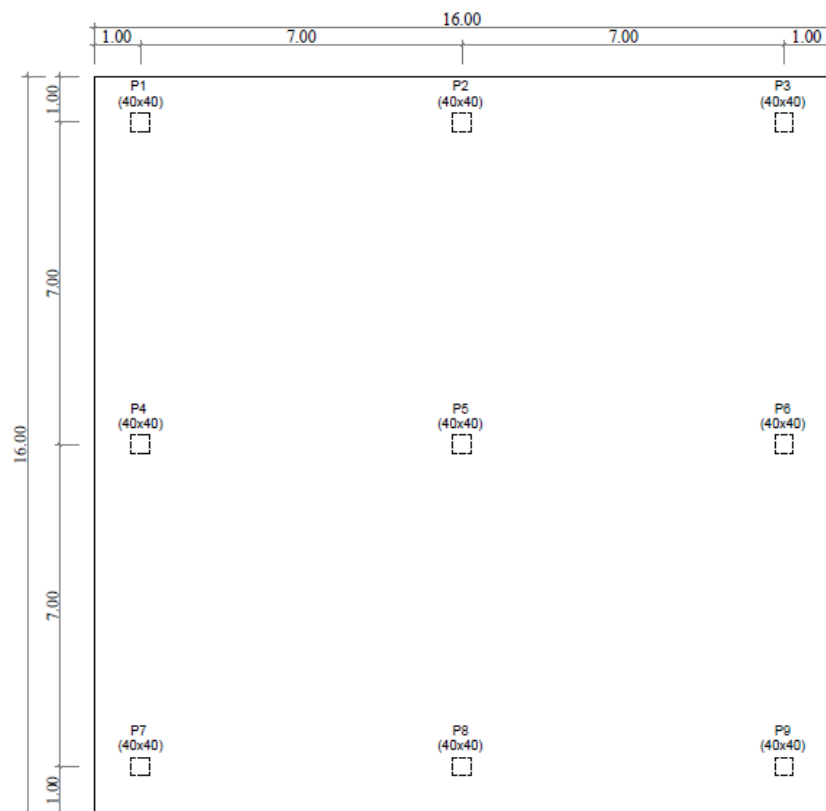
Planta baixa da laje lisa com armadura de cisalhamento
